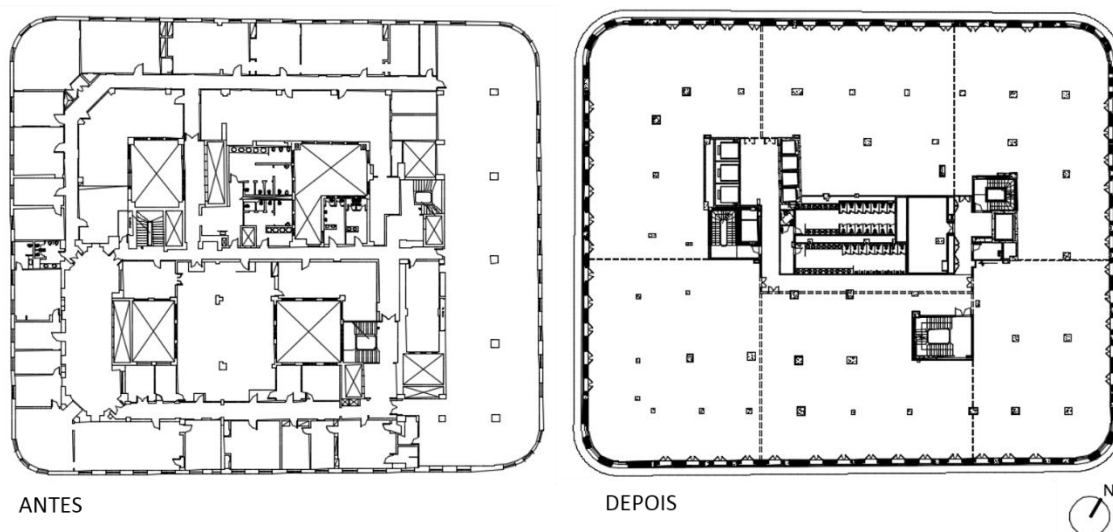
Planta baixa do 4º pavimento, antes e após reabilitação. Fonte: Ecotech (2011).
